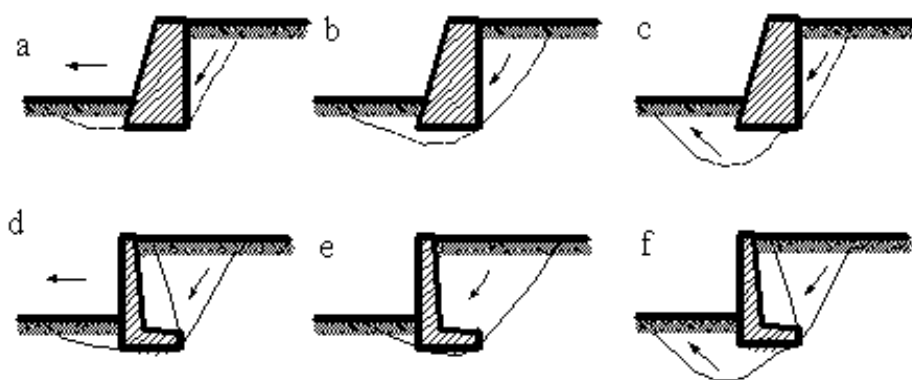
Примеры предельных режимов для случаев разрушения фундамента подпорных стен
